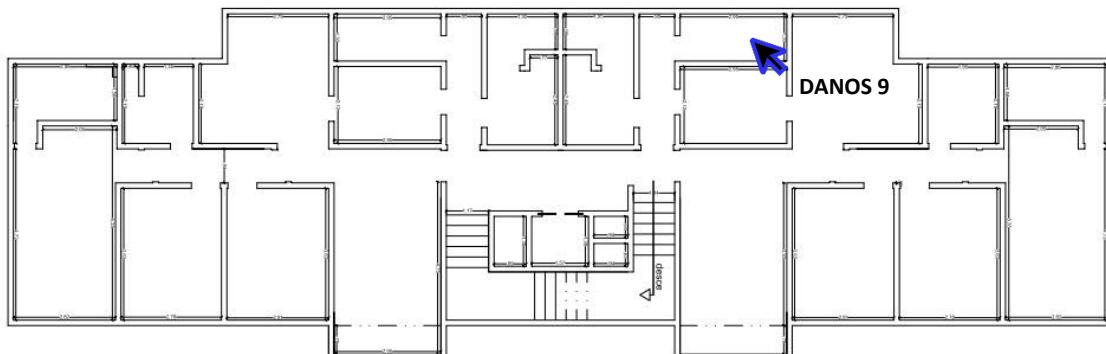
Planta Baixa (croqui) do Pavimento do 5º andar – Bloco C – Cond. Armando Lôbo.
